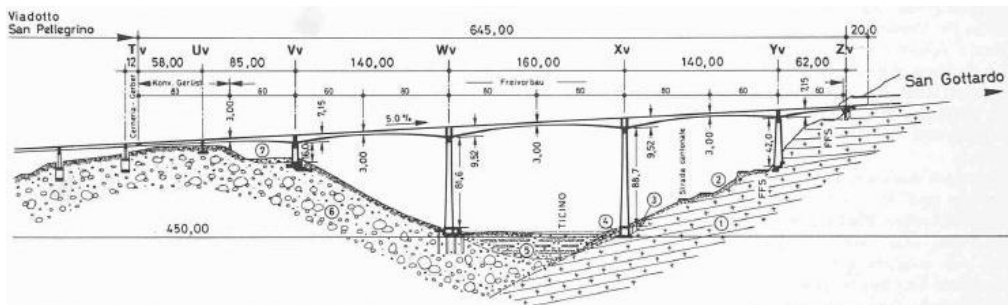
Längsschnitt durch den Boden mit Foundation
